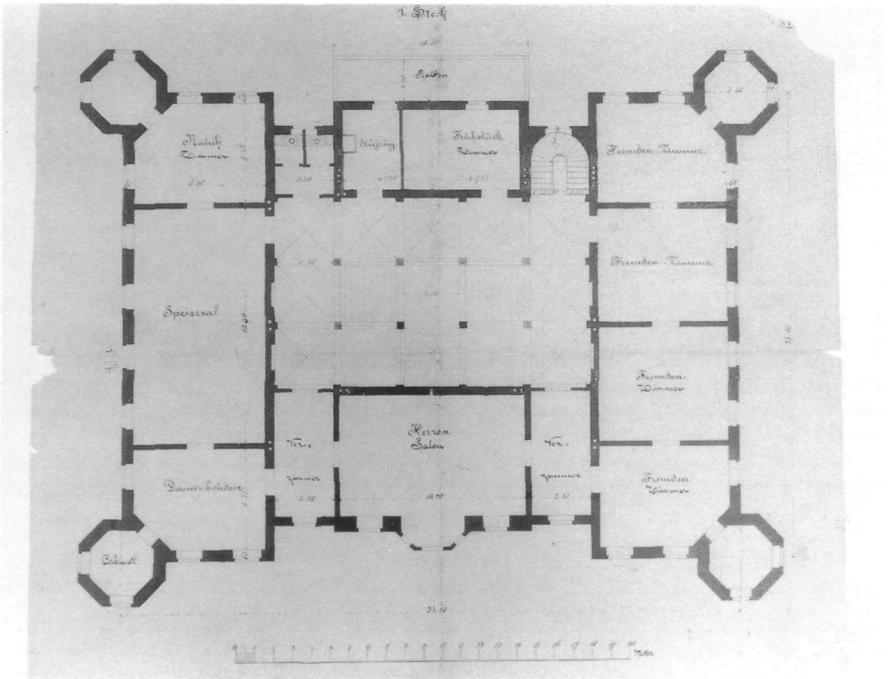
Grundriß (1. Stock), Anton Plochberger 1877.
